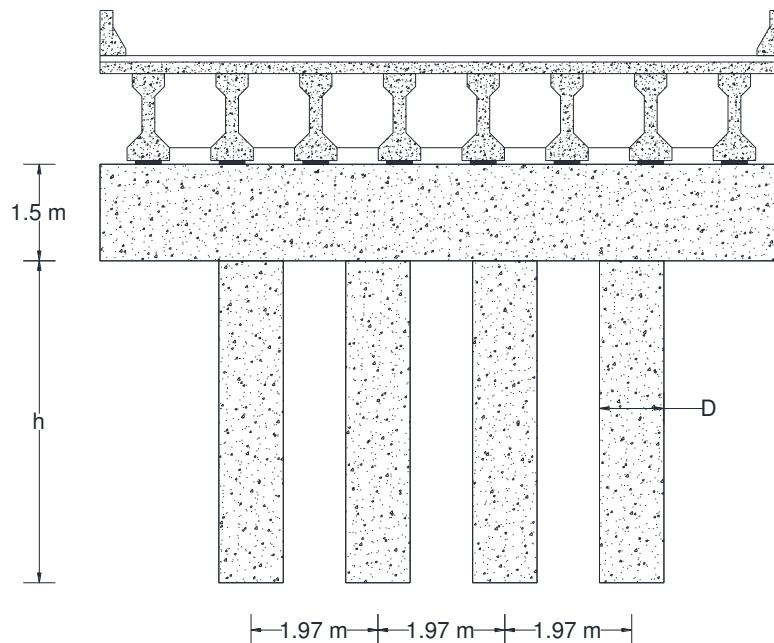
Marco tipo utilizado en los modelos estructurales.
